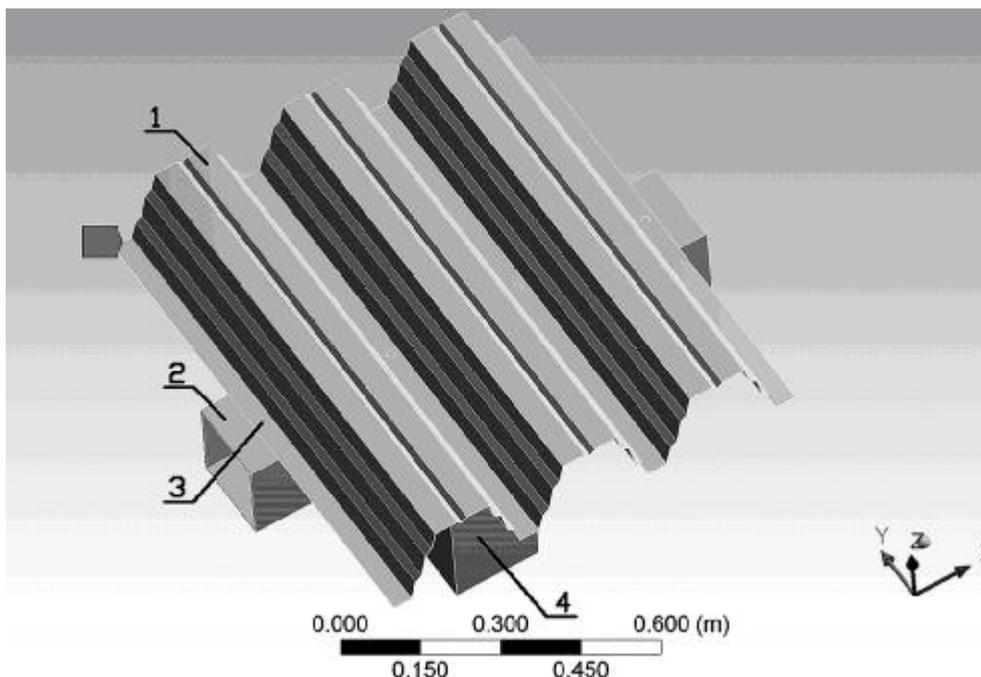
Расчетная схема узла опирания профилированного настила на верхний пояс фермы из ГСП
